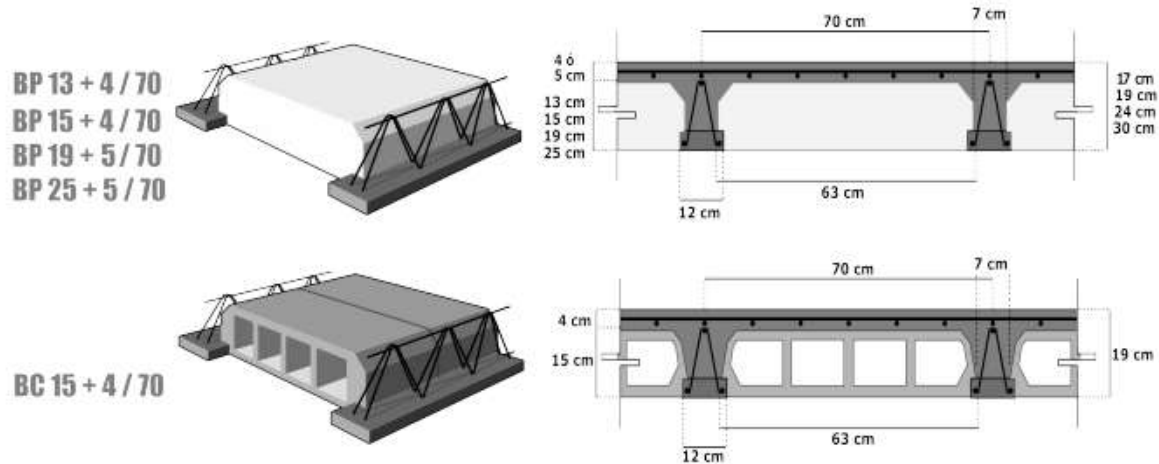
LOSA DE VIGUETA Y BOVEDILLA
